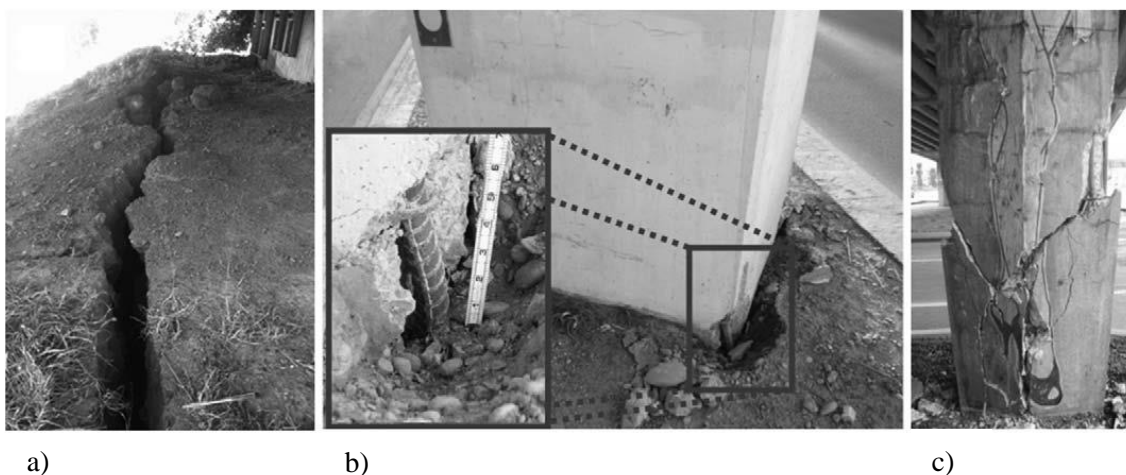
Danos em pontes em zonas não liquefeitas: a) rotura do talude na Horotane Overpass; b) fendilhação da base do pilar e encurvadura da armadura no Port Hills Overpass; c) rotura do pilar por corte na Moorhouse Avenue Overbridge.
